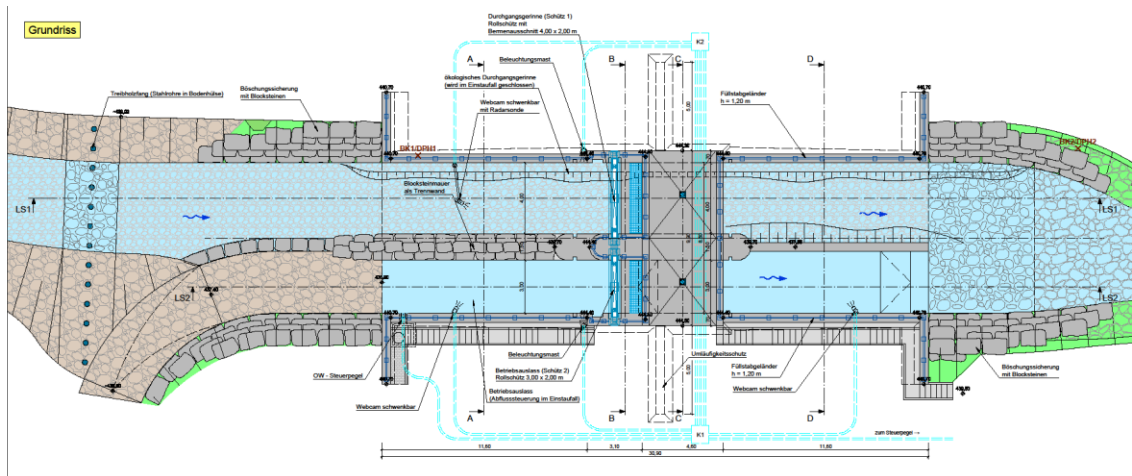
Unmaßstäblicher Grundriss des Auslassbauwerkes (Quelle: WALD + CORBE CONSULTING MBH, 2018)
